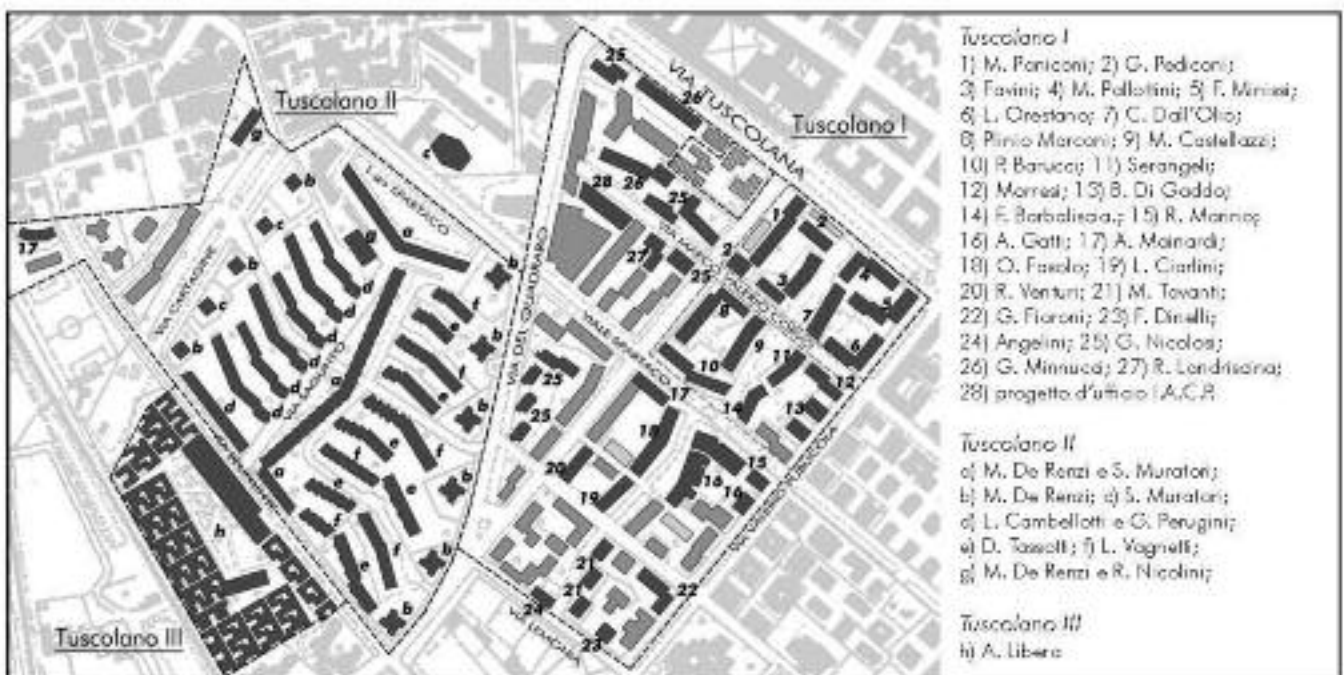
Planimetria generale, con l'individuazione dei tre settori
